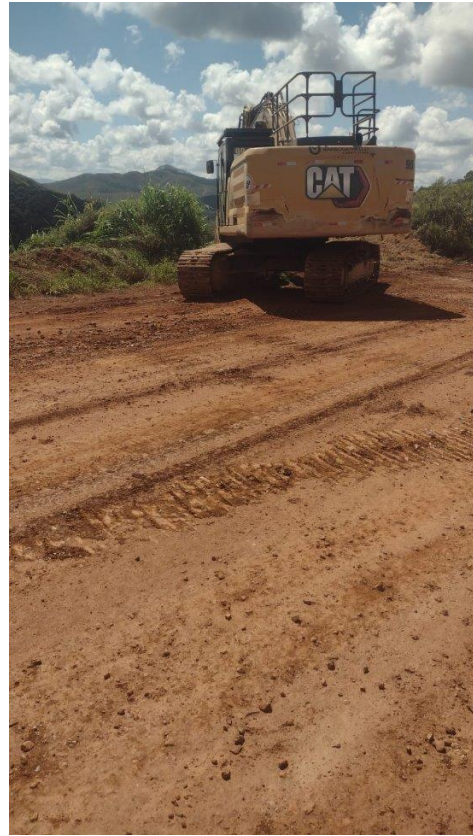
e Foto 37: Execução da remoção de topsoil pela Construtora Barbosa Mello (fonte: Vale, 2024).
